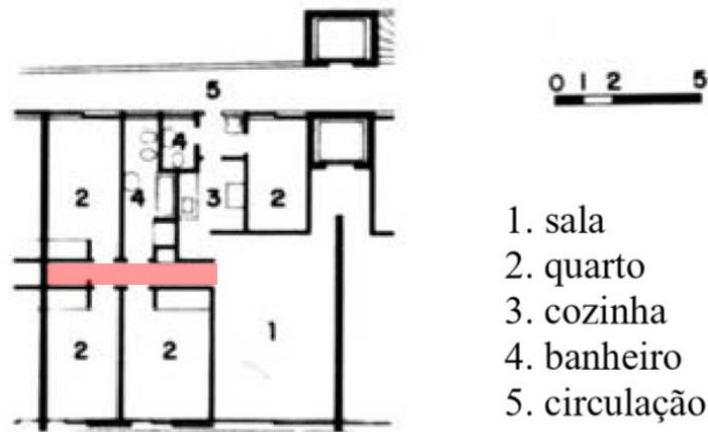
Planta baixa do edifício Anchieta, avenida Paulista, M. M Roberto, 1941. Adaptação da autora.
